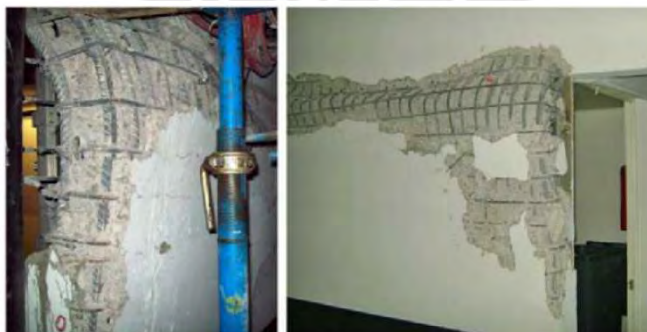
Pandeo lateral en muros de concreto armado. Tomado de Wallace et al., 2012.
